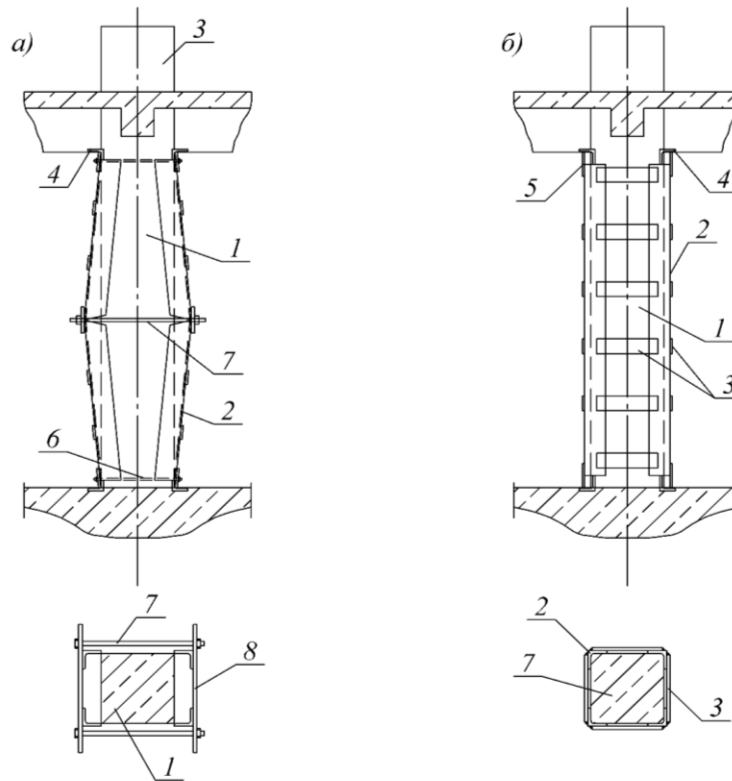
Усиление колонны предварительно напряженными двухсторонними металлическими распорками
